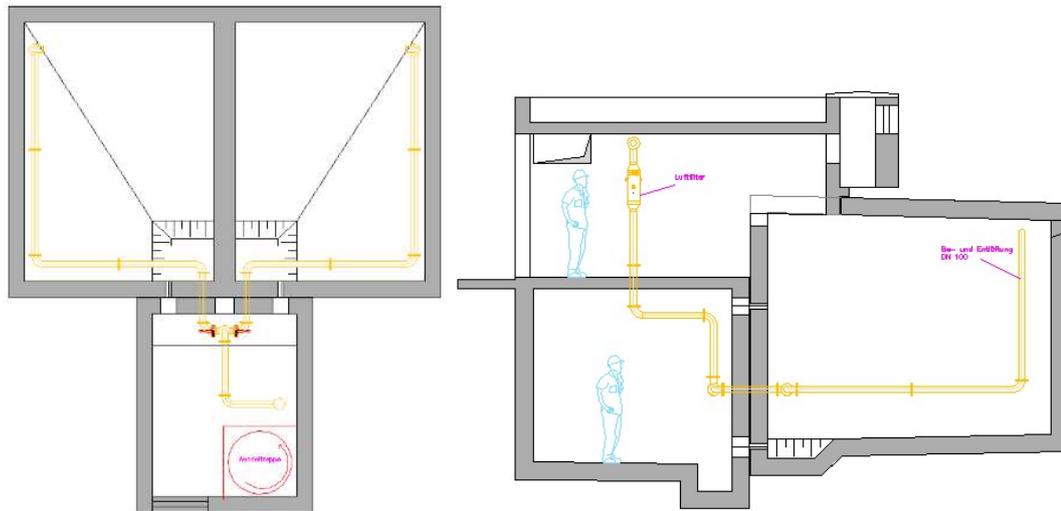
Beispiel für eine Kammer Be- und Entlüftung im Grundriss und im Schnitt
